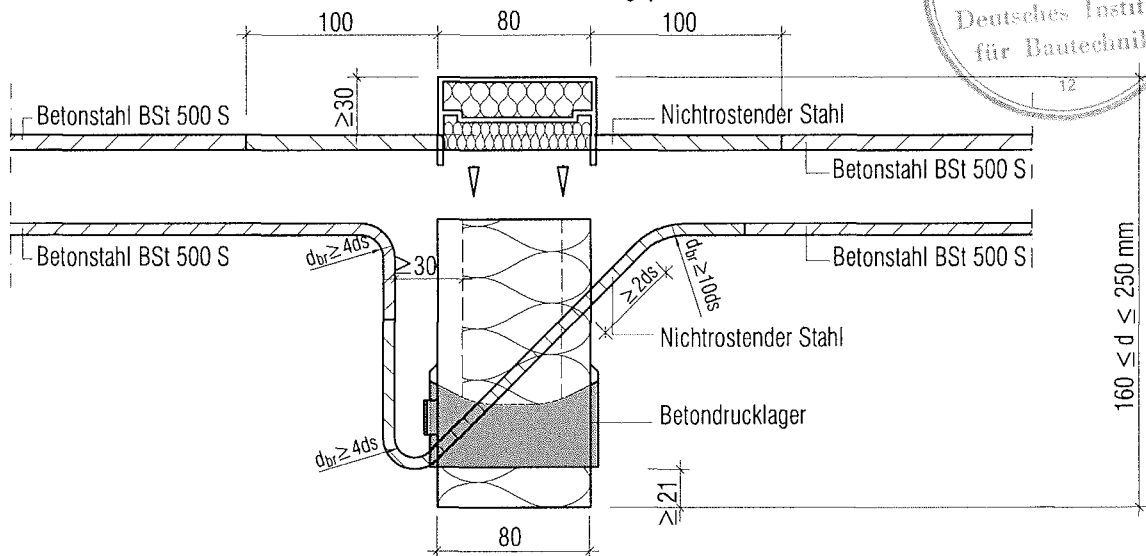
Schöck Isokorb Typ KF mit Druck- Querkraft Kombination und integrierter Aufhängebewehrung
